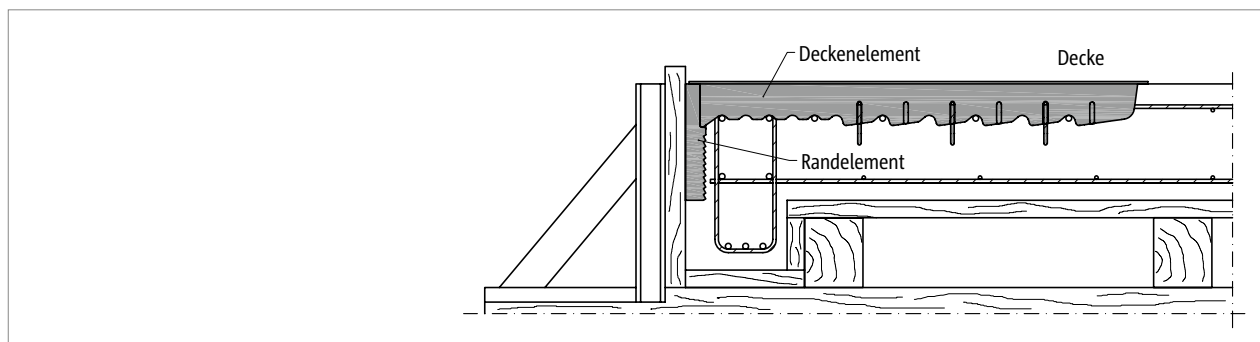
Schöck IDock®: IDock2, Randunterzug als Auflager; die Deckenaussparung wird durch die beiden Komponenten Randelement und Deckenelement abgeschalt
